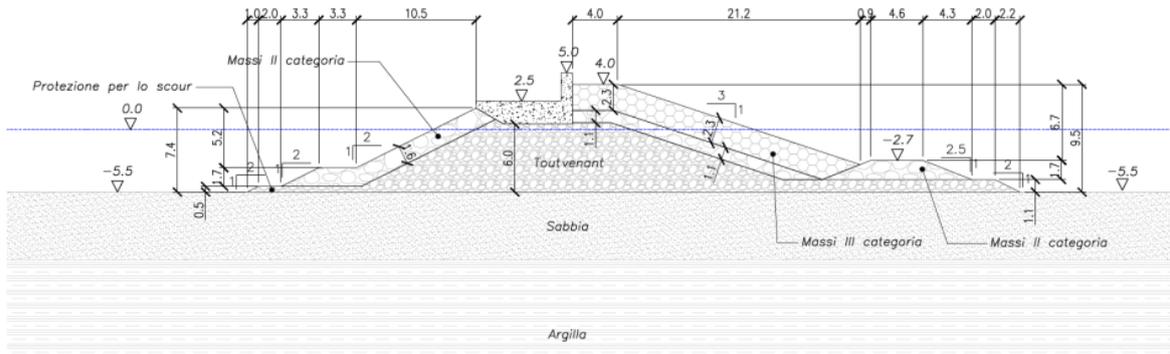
Sezione tronco molo Adriano (Sez. I)
